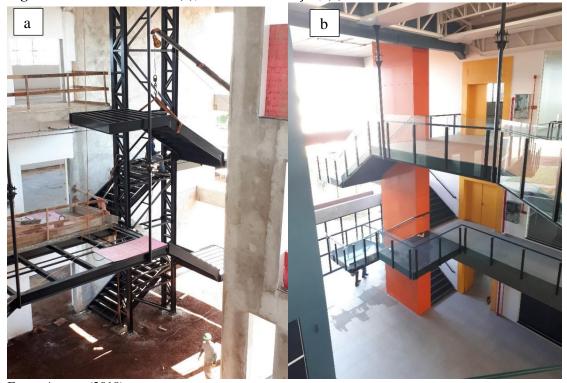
Escadas metálica (a), na fase de execução, (b) finalizada com revestimento.
